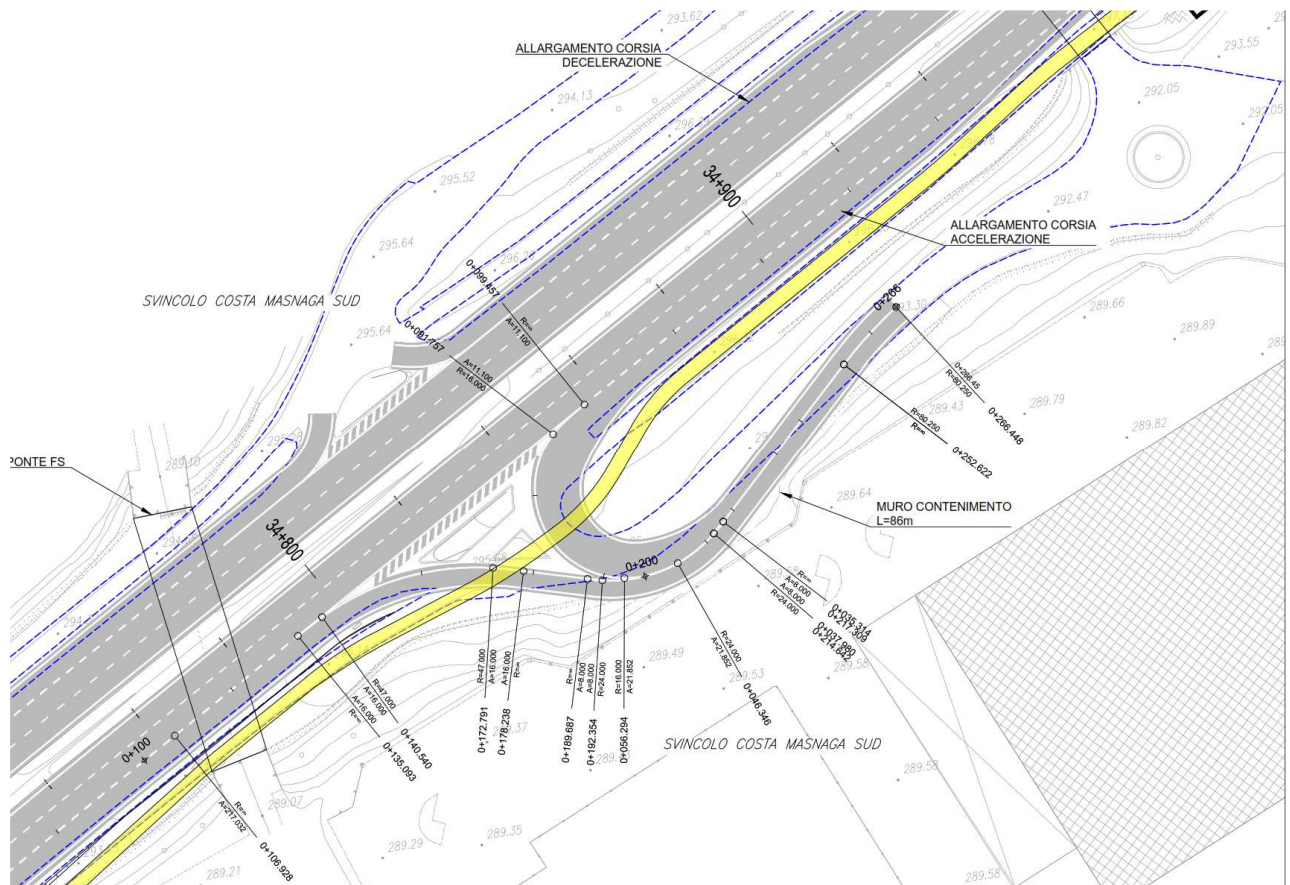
stralcio planimetria di progetto rampa di immissione di Costa Masnaga Sud
